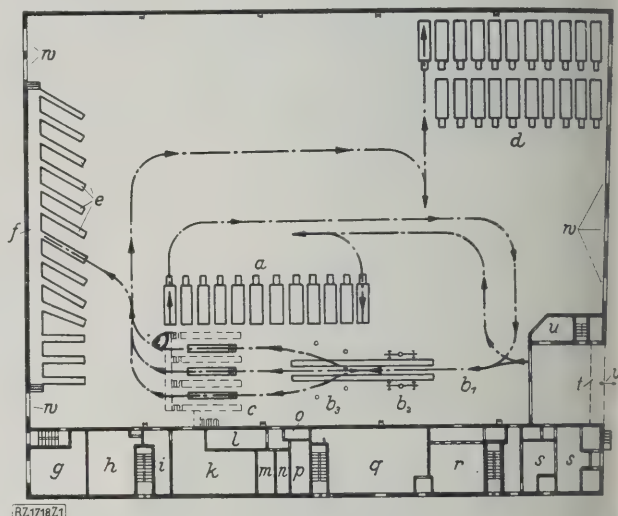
Betriebshof der Aboag in Treptow, Grundriß des Erdgeschosses.
